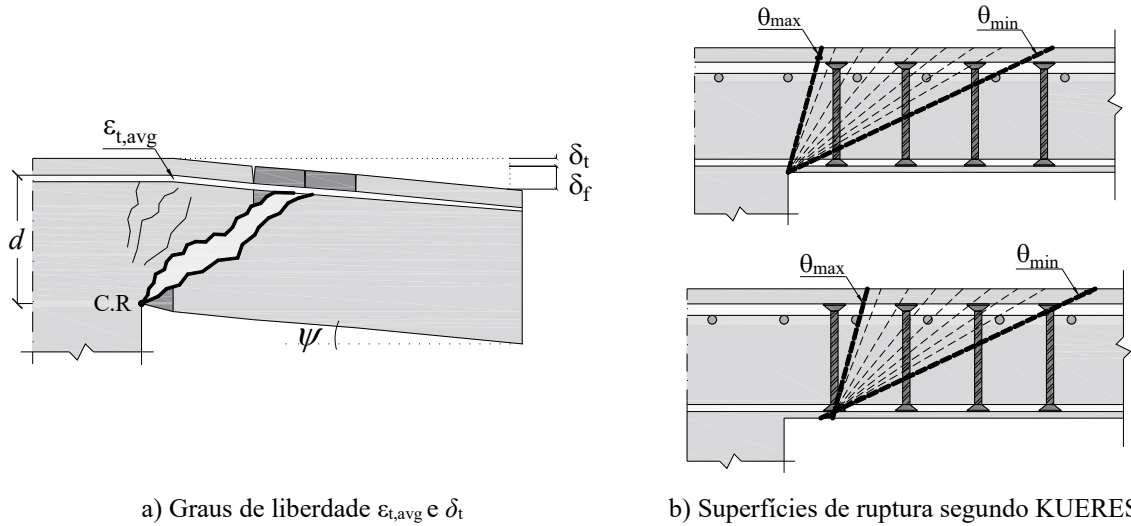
Two-Parameter Kinematic Theory* aplicado a ligações laje-pilar.
